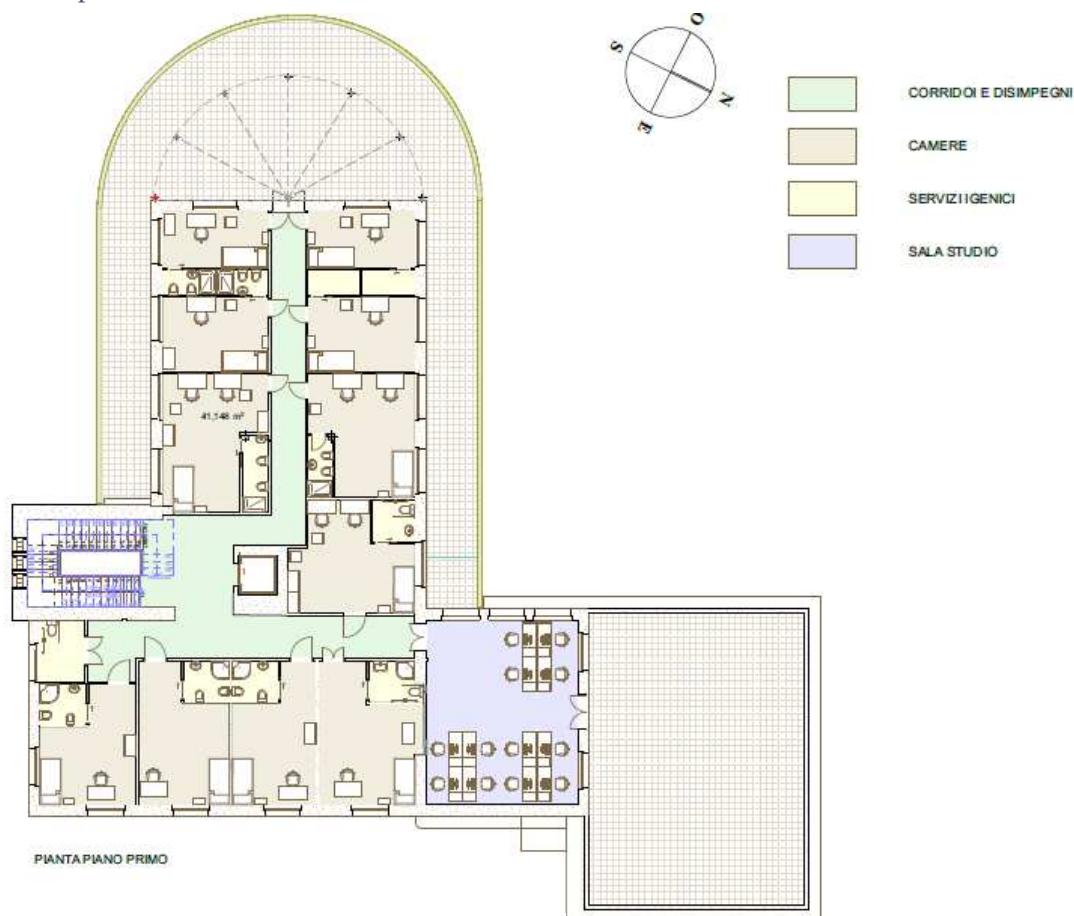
Pianta piano primo convitto, riferimento tav B2
